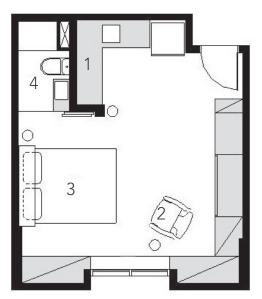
Planta Durante la noche forma 1 Nota: Plataforma Arquitectura
